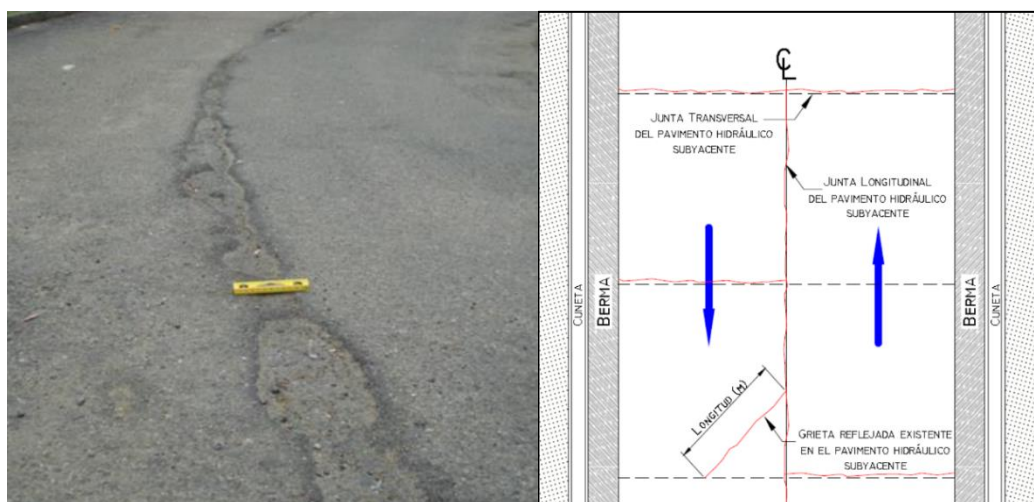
Fisura longitudinal y transversal de junta de construcción (FIJ)-(FTJ).
